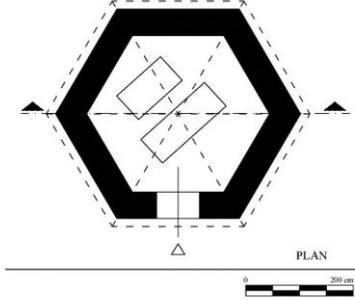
مسقط أفقي لتربة محمد باشا في بريزرن في كوسوفو
